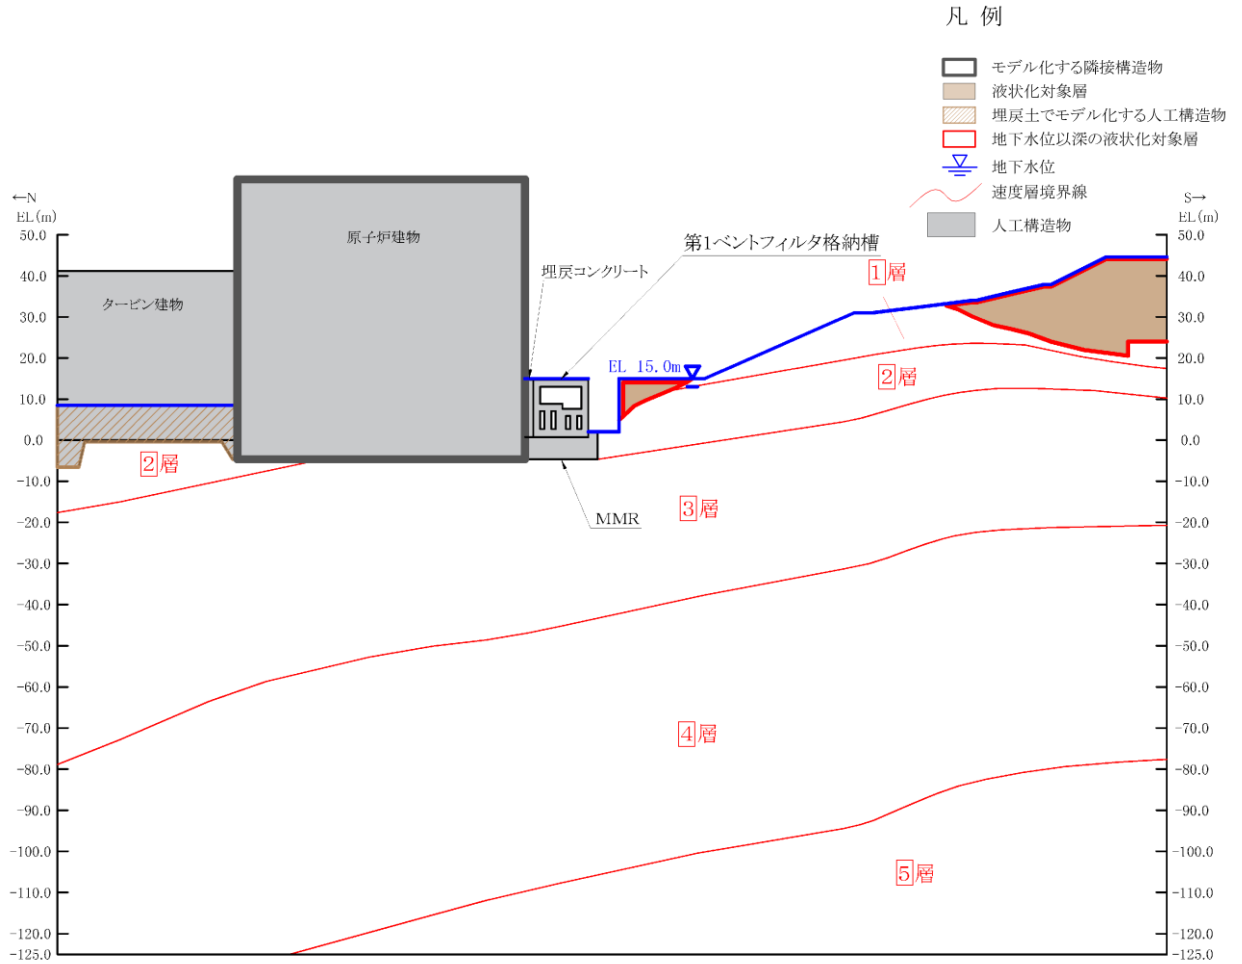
第 1 ベントフィルタ格納槽 評価対象断面図 (B-B 断面位置)
